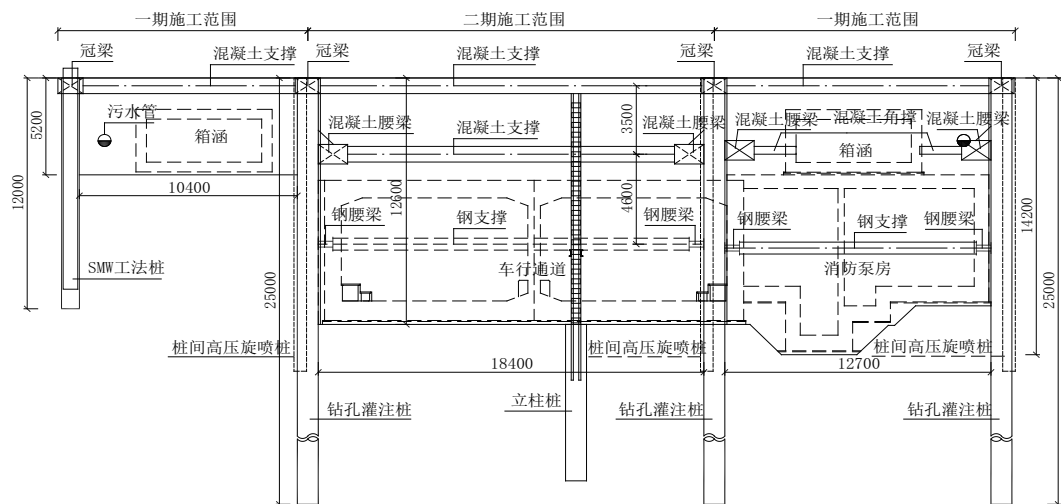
消防泵房处共建基坑支护横断面图(单位:mm)
